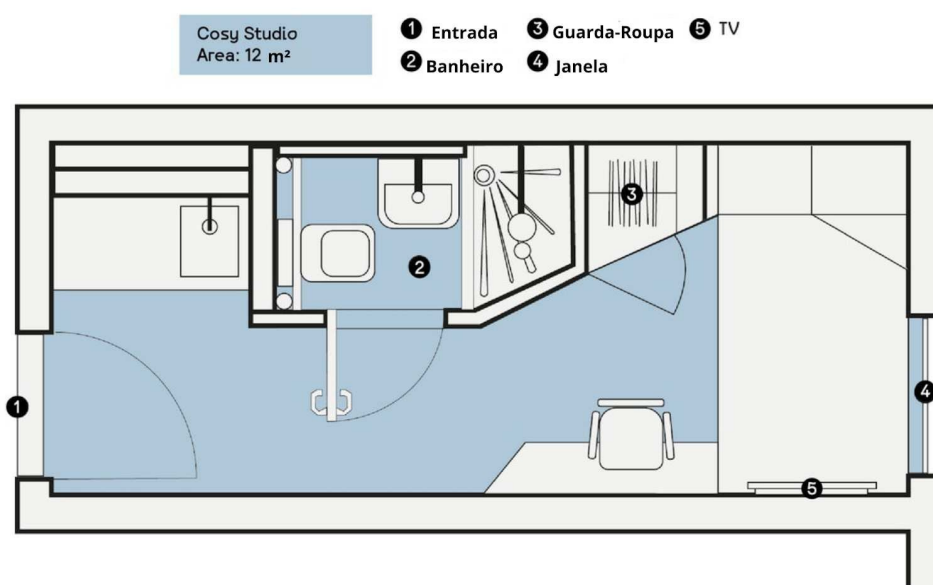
Planta baixa quarto tipo 02-Cosy Studio
